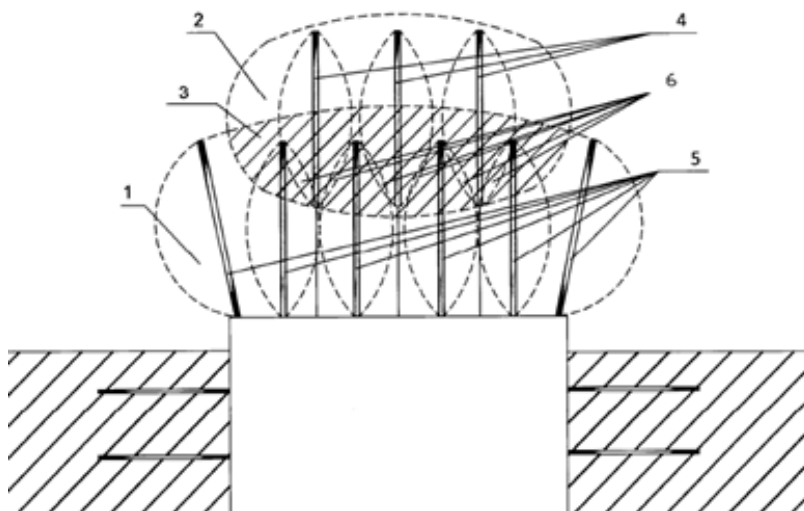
Схема двухуровневое крепление кровли выработки
